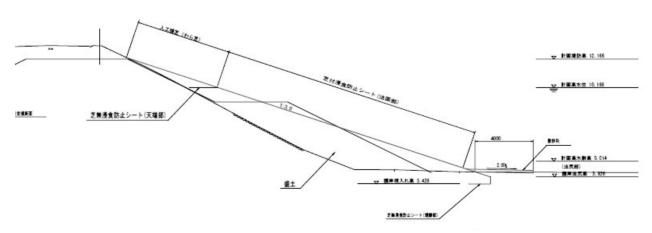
標準断面図(高梁川西阿知堤防/断面拡大)
